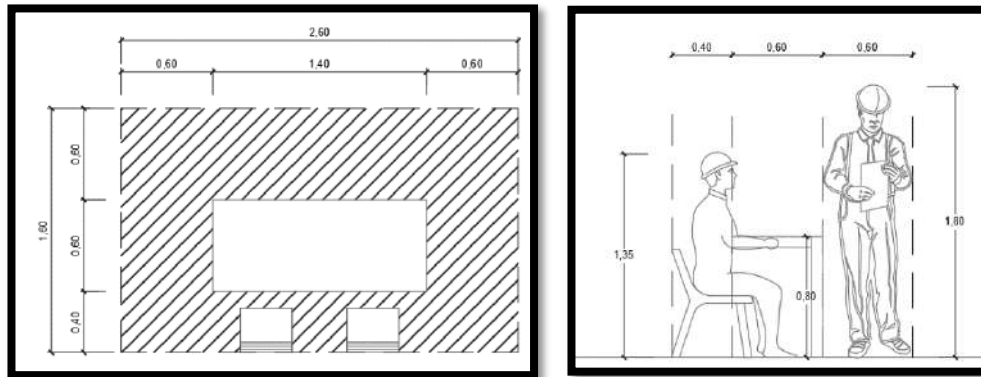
Planta y elevación de escritorio para aula de teoría, correspondiente
